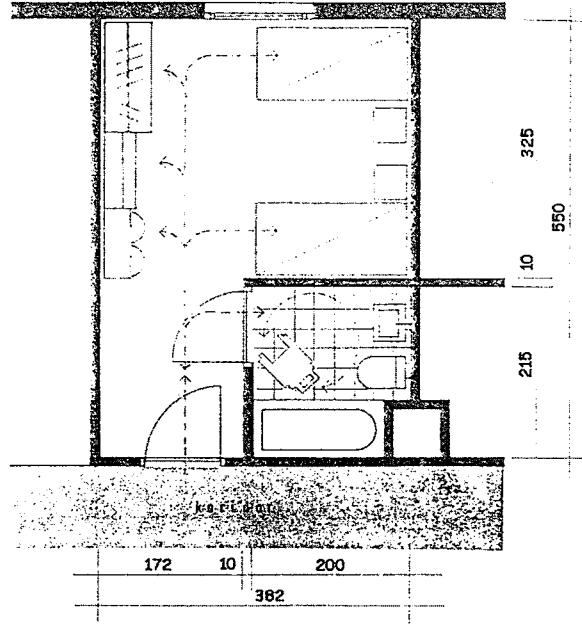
Tek kişilik yatma+oturma+wc+banyo+mutfak planı [35]
